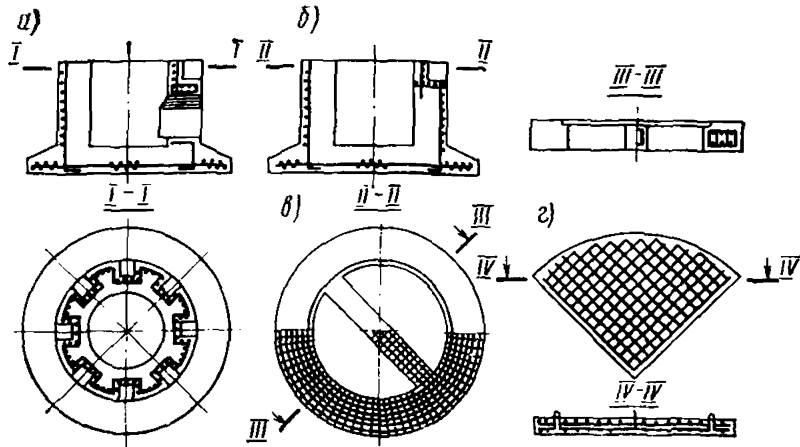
Принципиальные схемы армирования опорной и цокольной частей фундамента дымовой трубы
